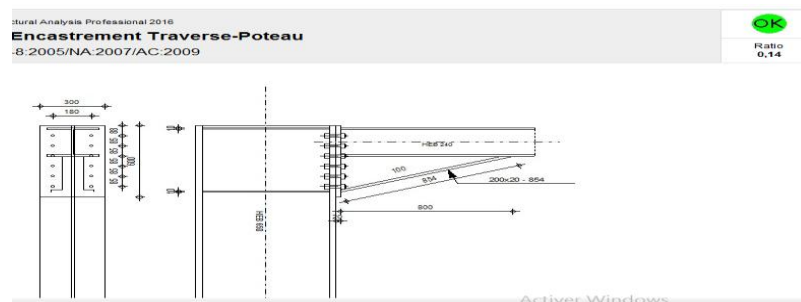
Schéma d'assemblage poteau-poutre (HEB650-HEB240)
